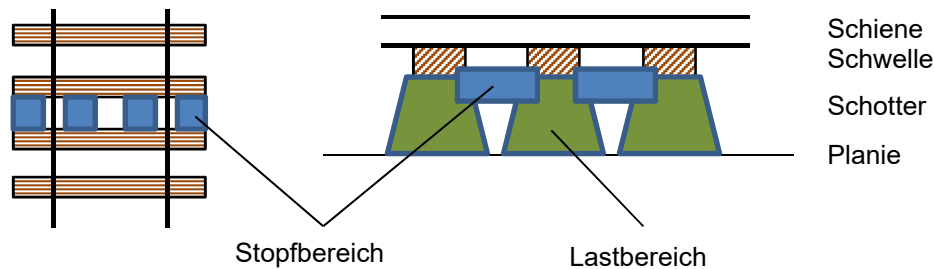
Grundriss (links) und Aufriss (rechts) des Oberbaus mit Darstellung der Stopf- und Lastbereiche im Schotterbett
